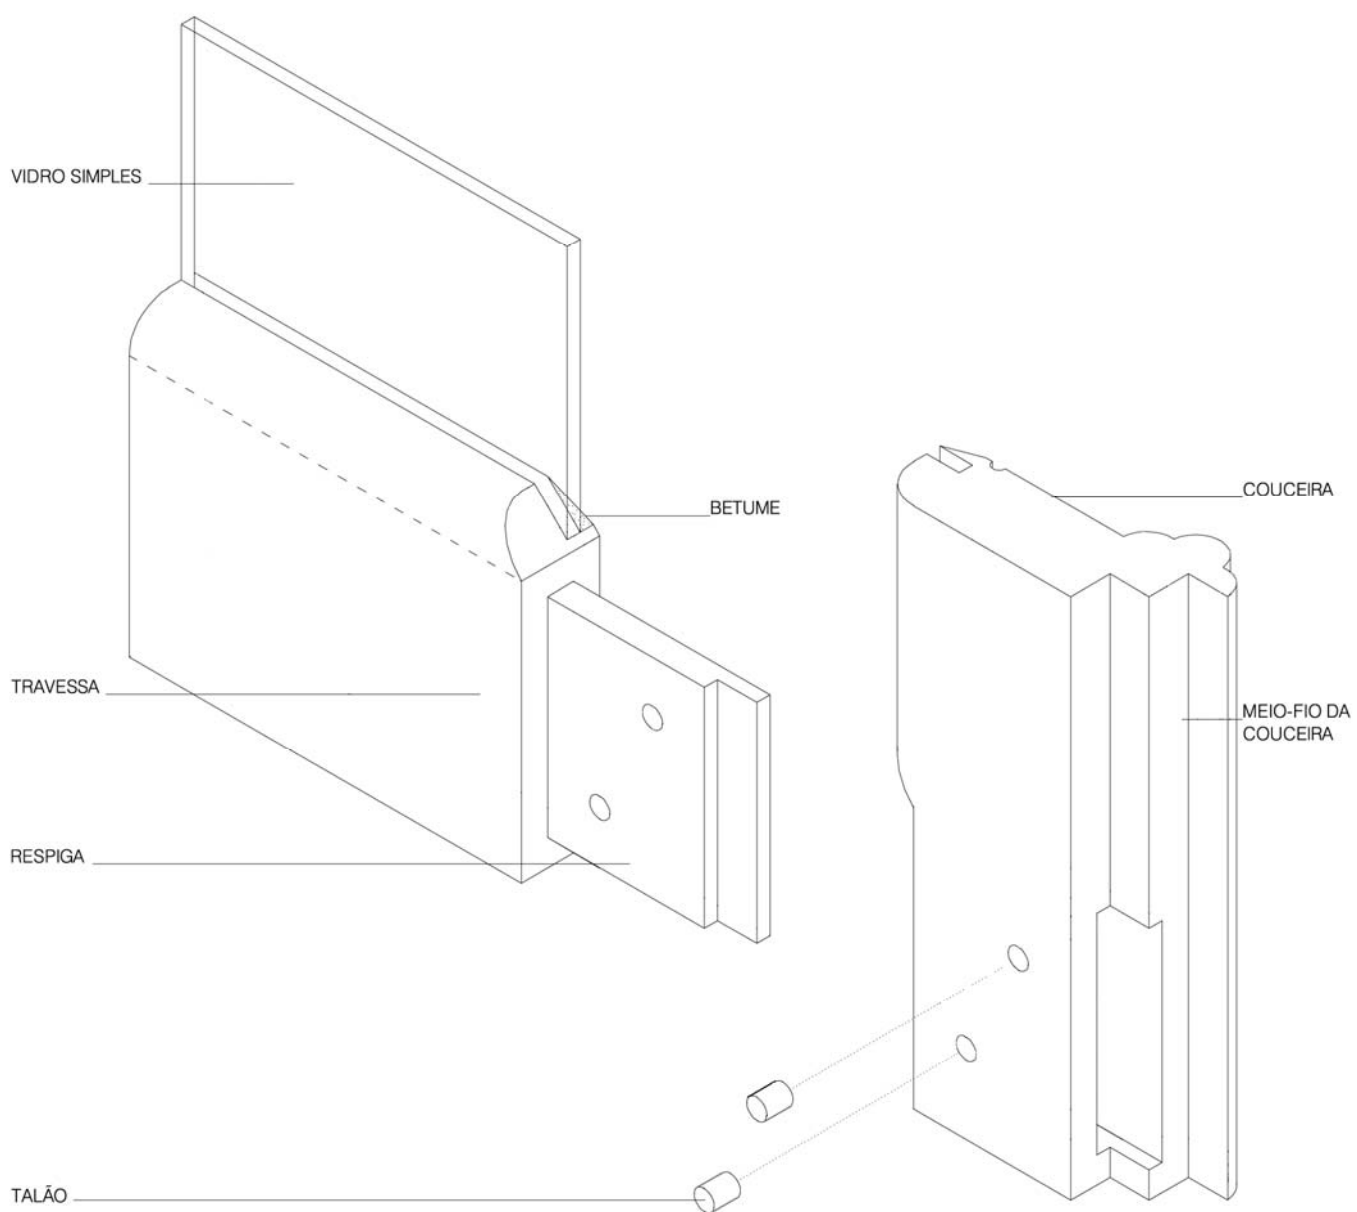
Pormenor do encaixe corrente entre travessa e couceira.
